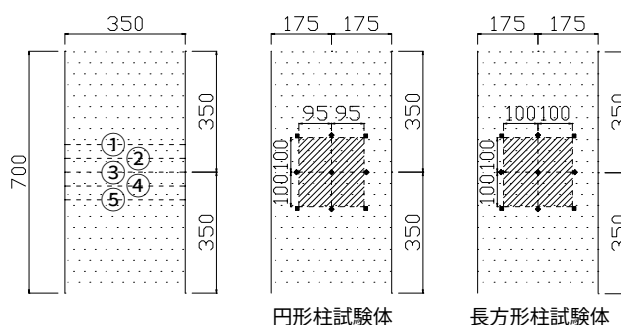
ひび割れ幅測定位置及び損傷評価領域
